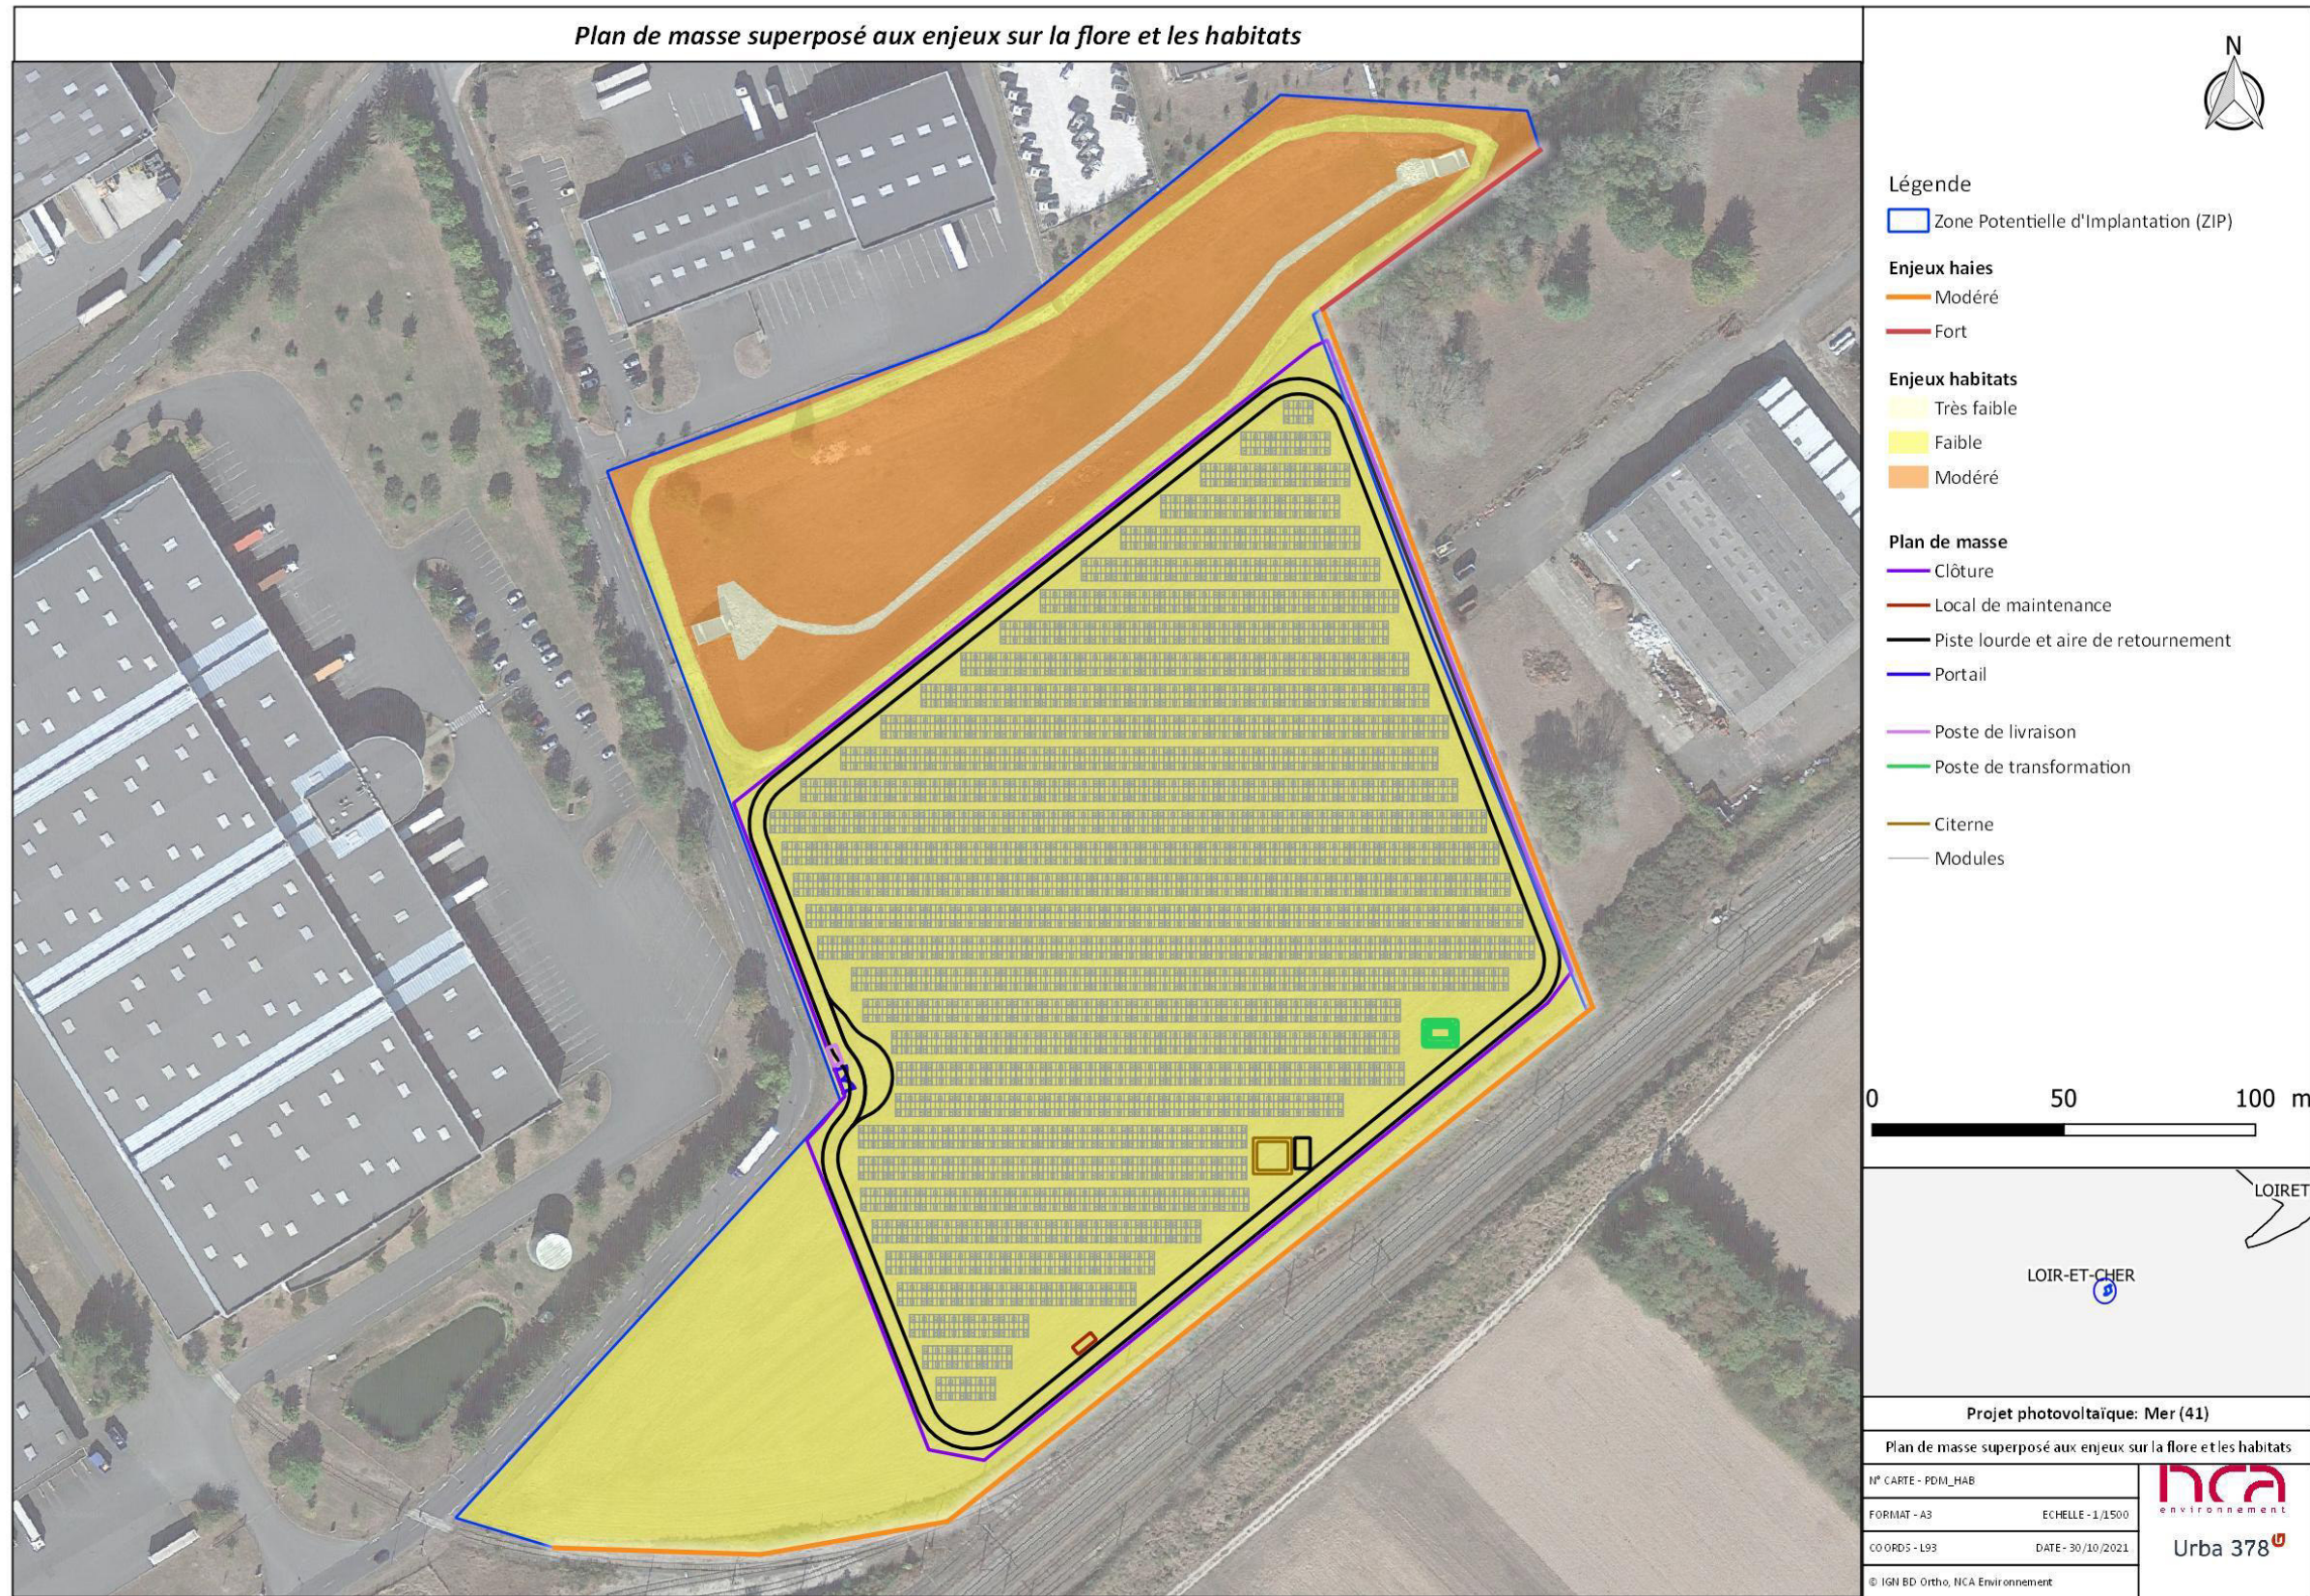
Plan de masse superposé aux enjeux sur la flore et les habitats
